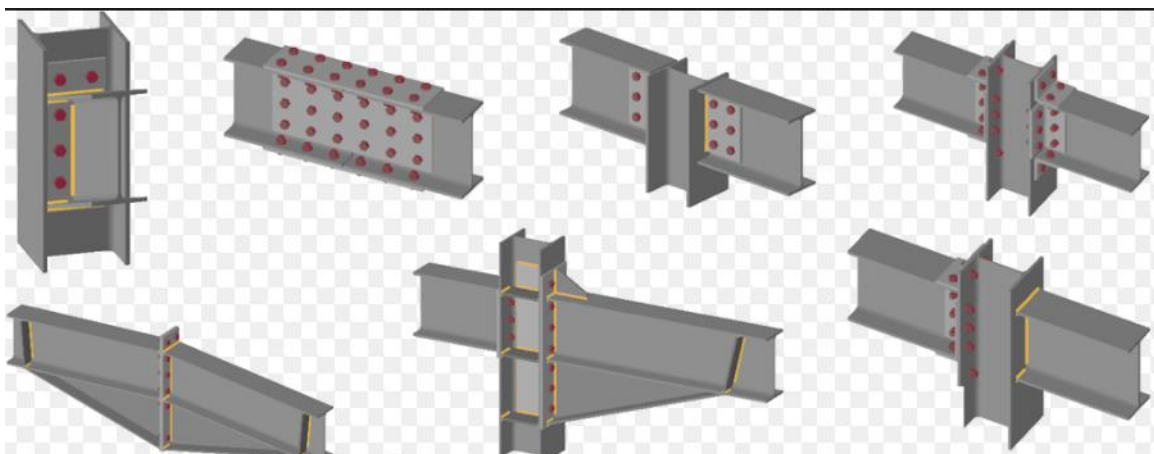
Tipos de ligações aparafusadas mais usuais em estruturas metálicas (Martins, 2008)
